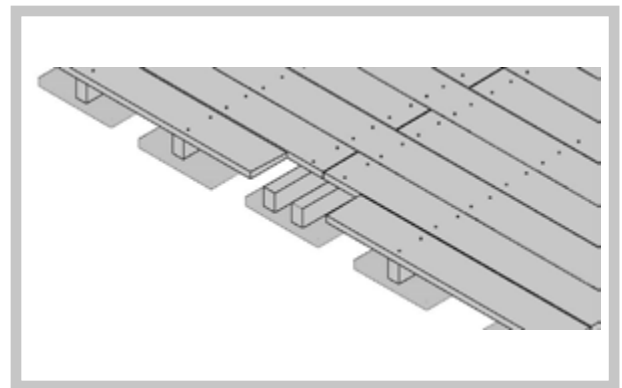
Stoßfugenausbildung und richtige Verschraubung
